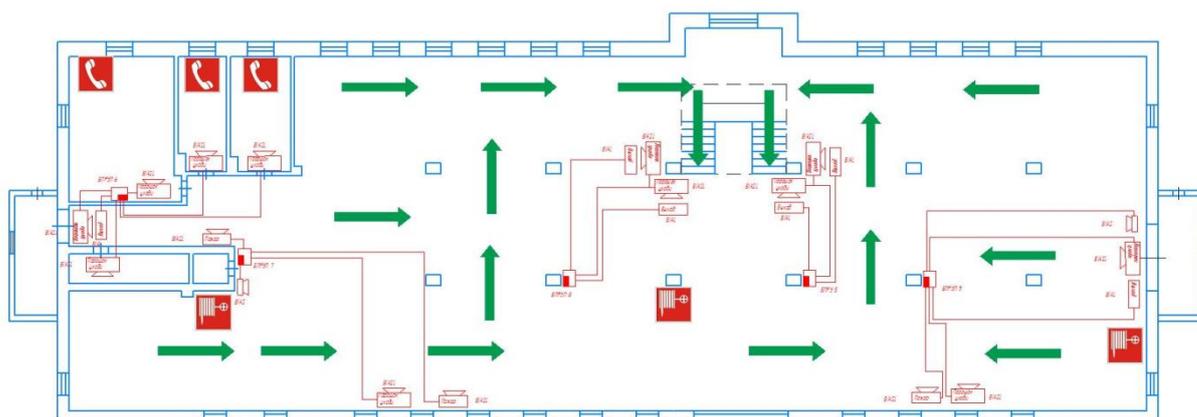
Планы эвакуации из помещений 2-го этажа
